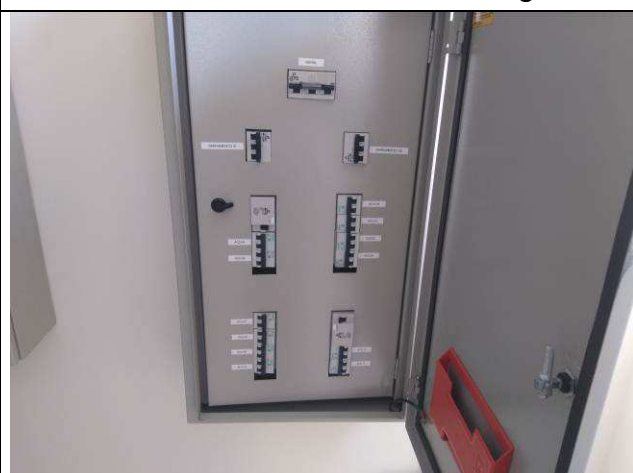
E: disjuntores e alimentadores quadro elétrico do 2º pavimento.
